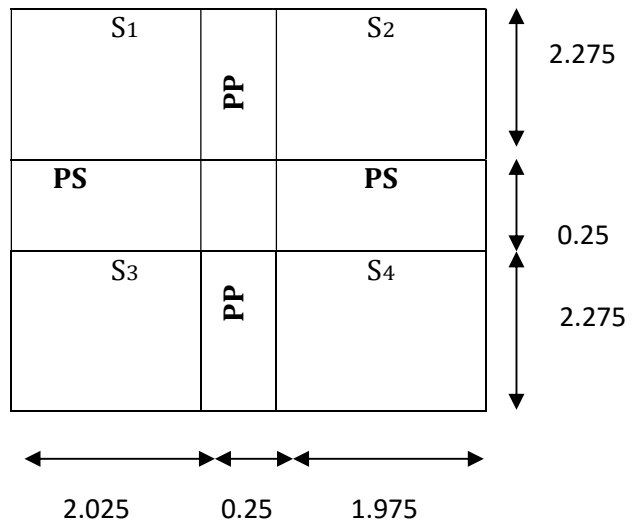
Surface du plancher revenant au poteau B4 le plus chargé
